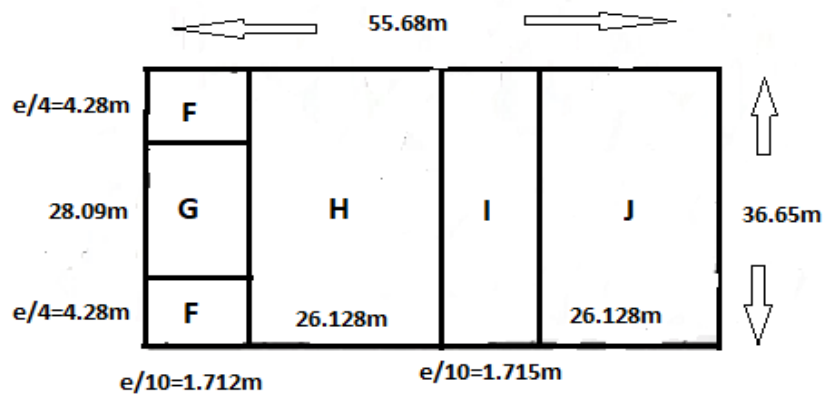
représentation des zones de pression sur la toiture suivant V2
